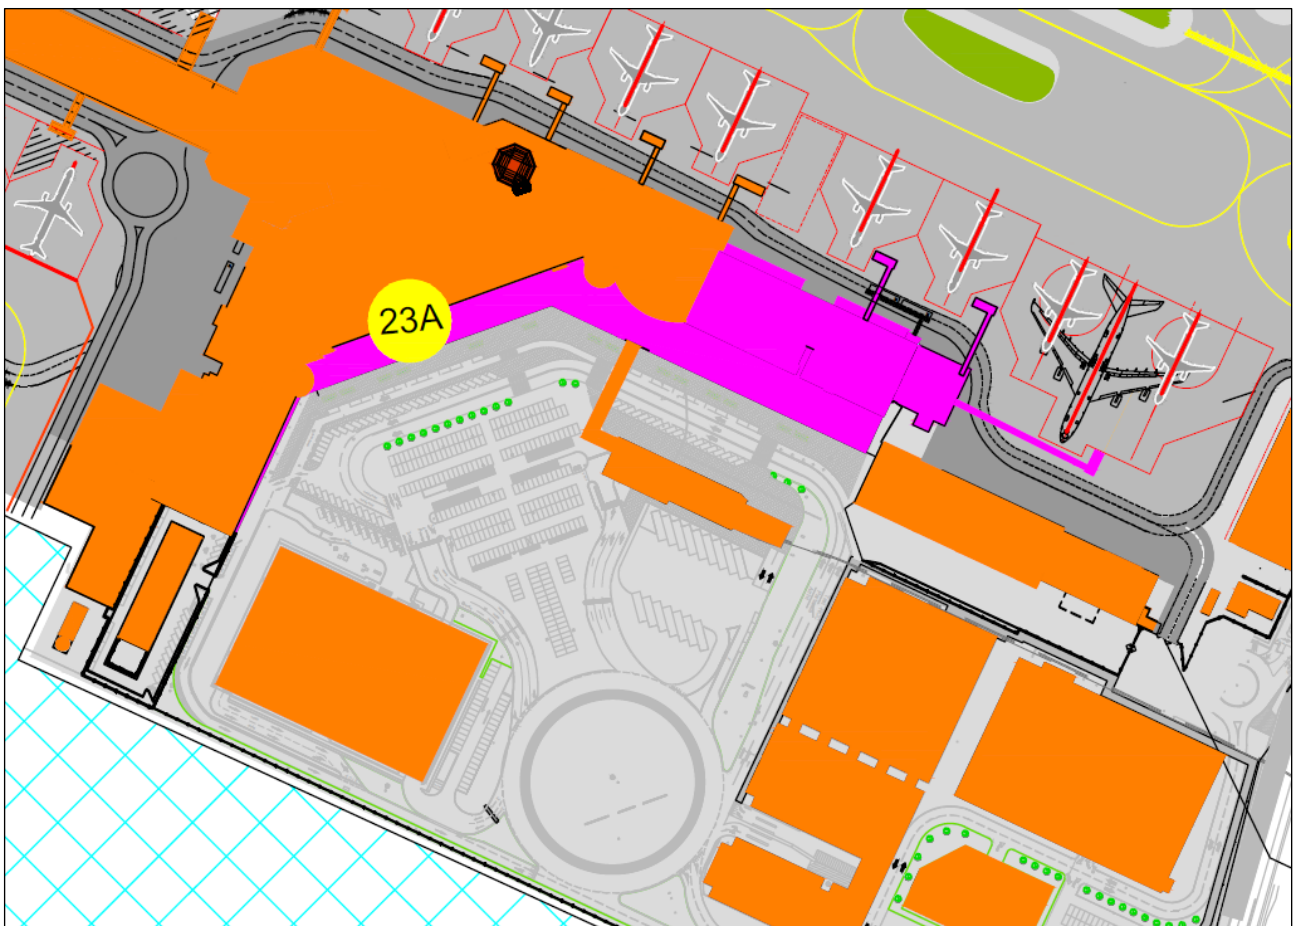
Estratto Master Plan – Ampliamento Aerostazione Est
